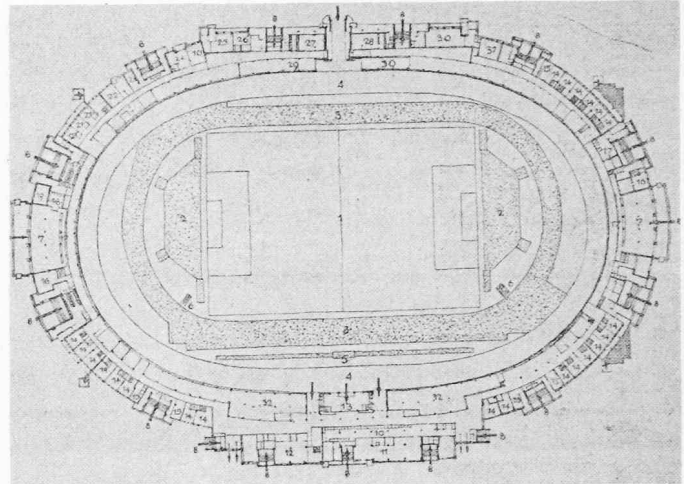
Olympia-Stadion in Amsterdam. Grundriss mit integrierter Radrennbahn
